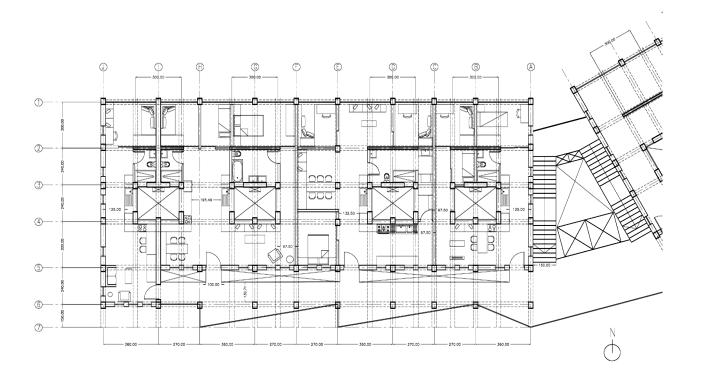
Referente de vivienda con sistema estructural pilar-viga
